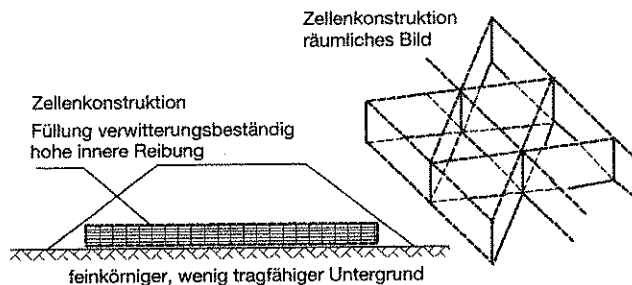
Bewehrung mit Zellenkonstruktion aus Geogittern
